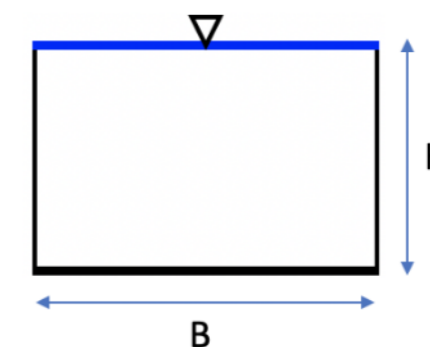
Esquema del marco de sección rectangular para obras de drenaje transversal. (Fuente: Elaboración propia).
